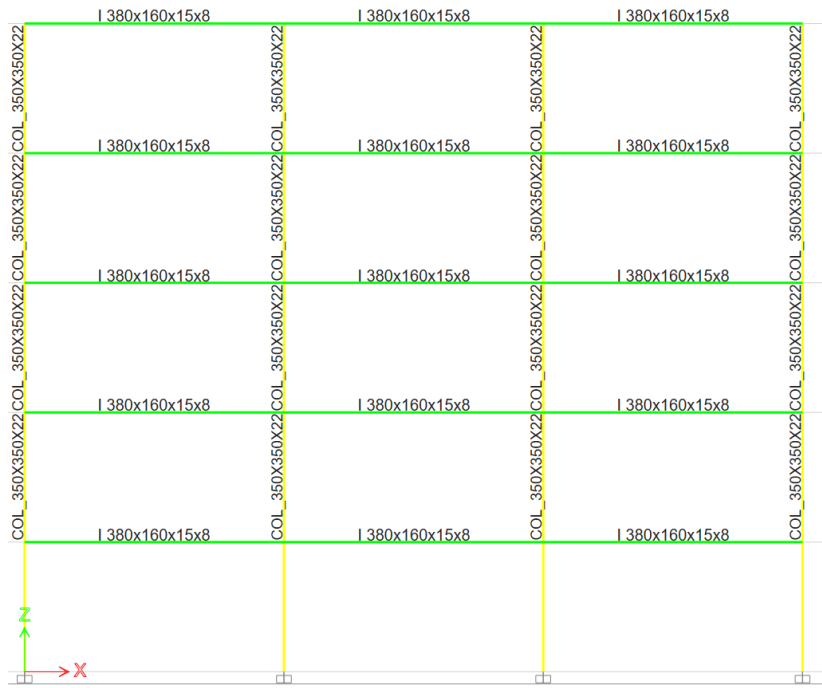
Modelo 2 Columna Tubular- Viga Tipo I
